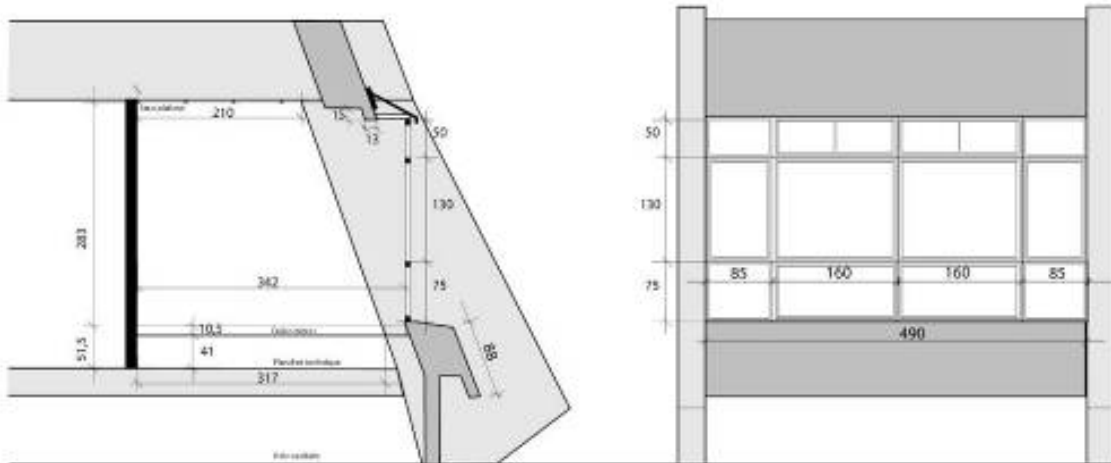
coupe transversale et façade nord-est de la cellule
